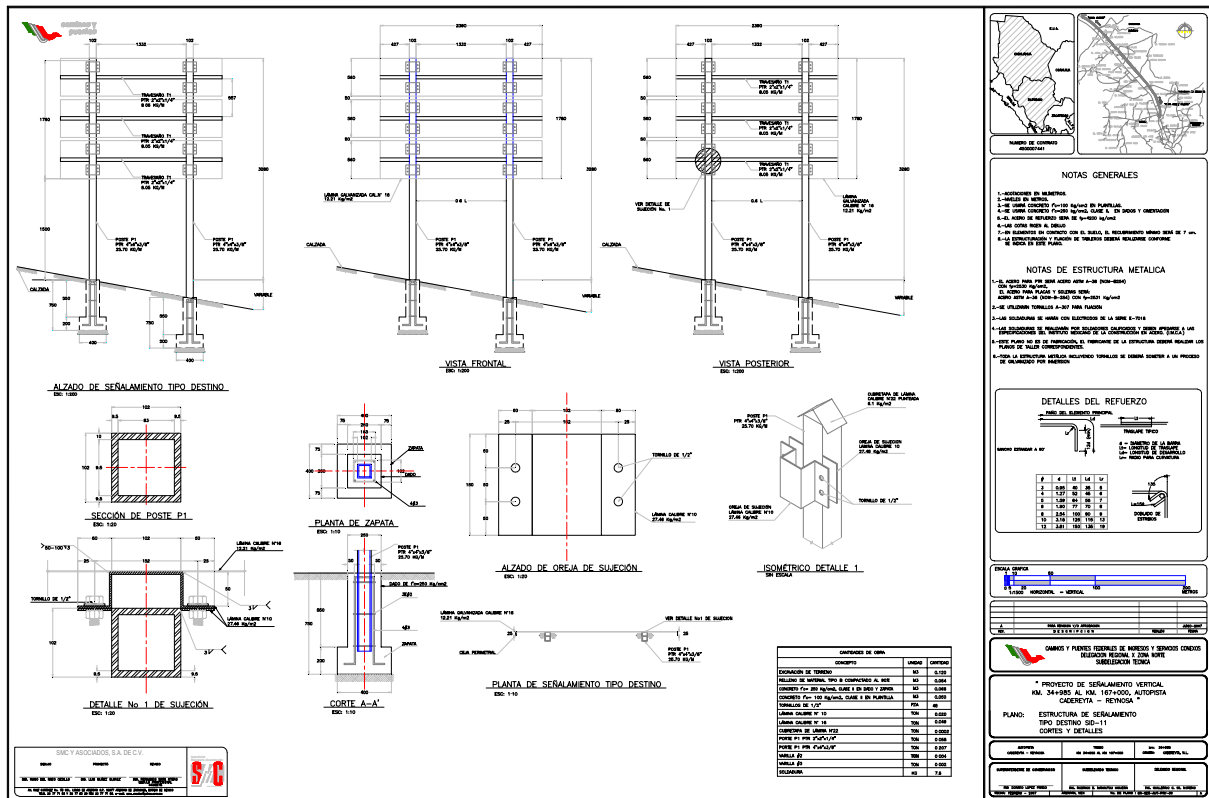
Ejemplo de plano estructural. ESTRUCTURA DE SEÑALAMIENTO TIPO DESTINO SID-11 CORTES Y DETALLES.
